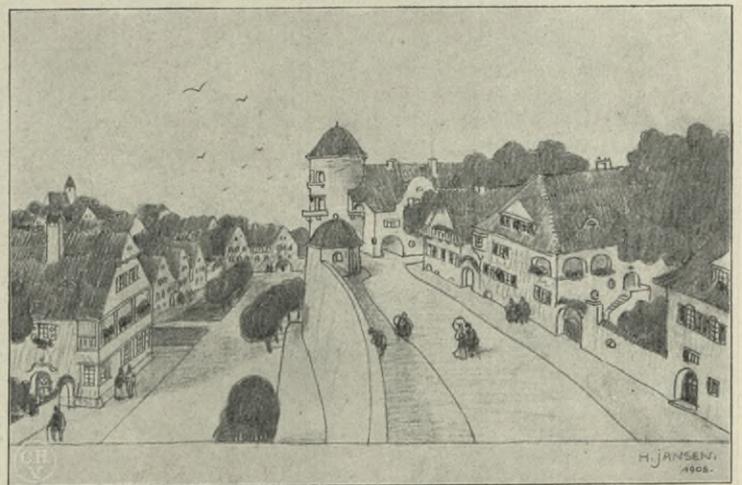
Aus Hermann Jansens Bebauungsplan für Frohnau, Wallstraße
